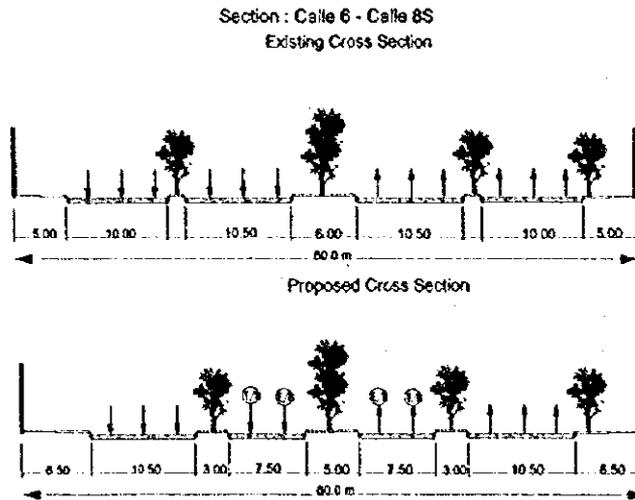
Sección Típica sobre la Avenida Quito (6)
